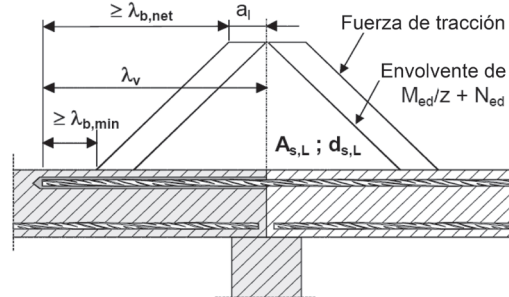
Anclaje de refuerzo para cubrir la línea de actuación de la fuerza de tracción.
